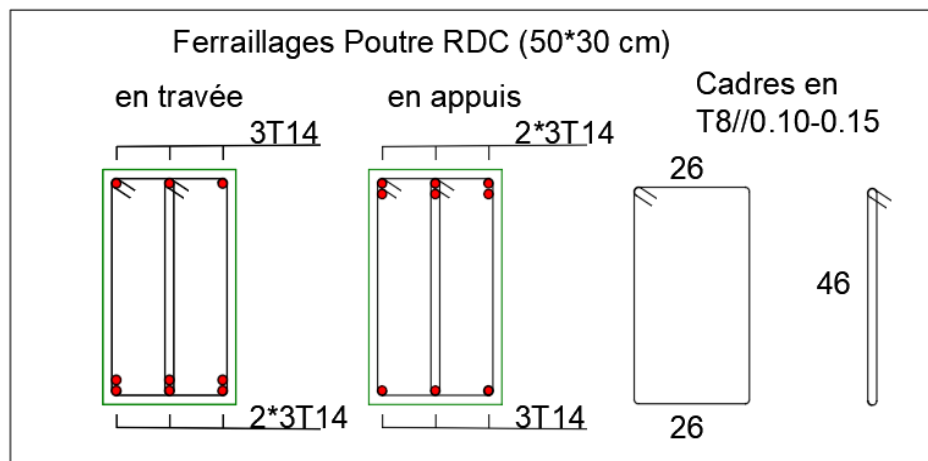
Ferrailages Poutre RDC 50*30 cm.
